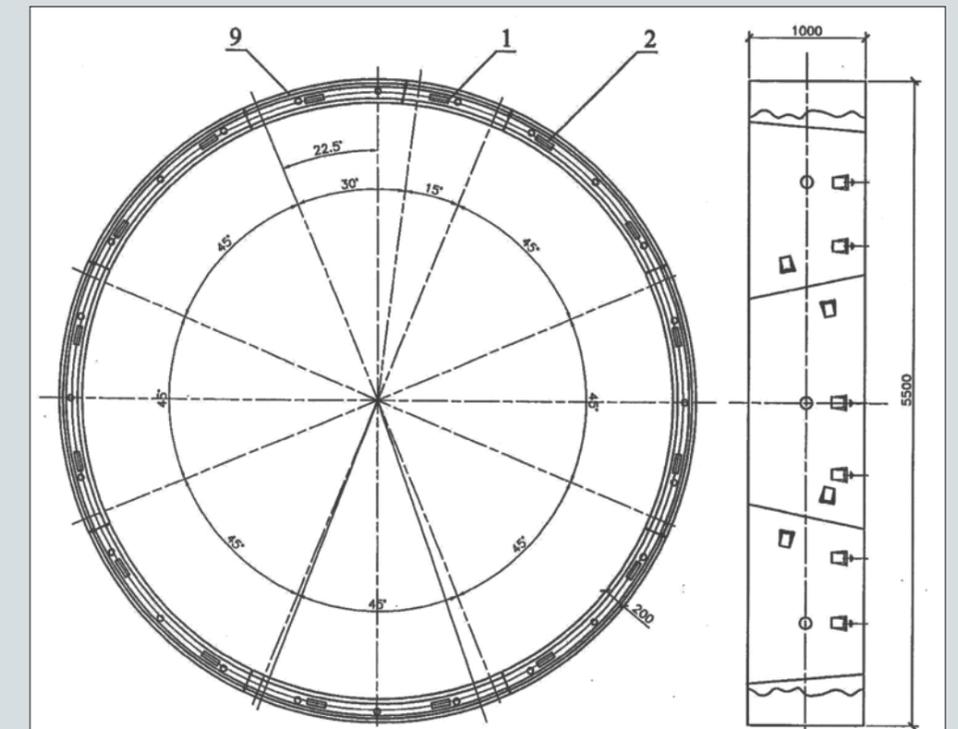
Сборная водонепроницаемая железобетонная обделка с упругими уплотнениями в стыках
